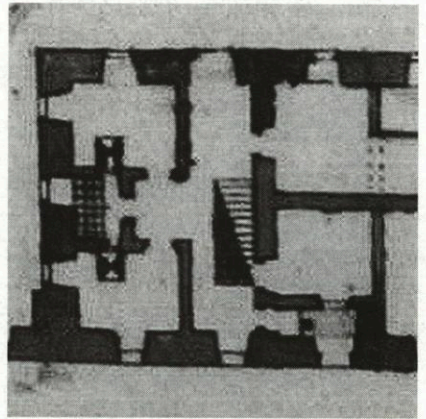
Obermünsterplatz 4, Erdgeschoss vor 1766 (Münchner Plan).
